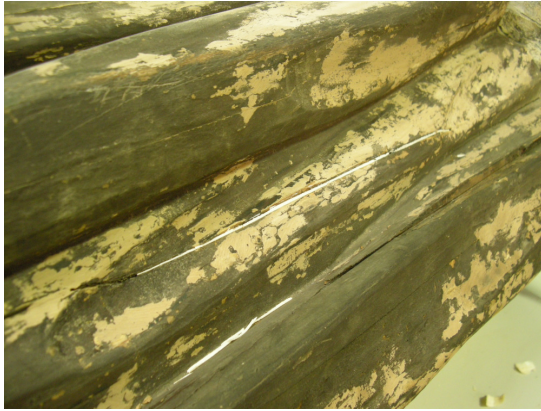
Pormenor do preenchimento das fissuras com madeira balsa e PVA
